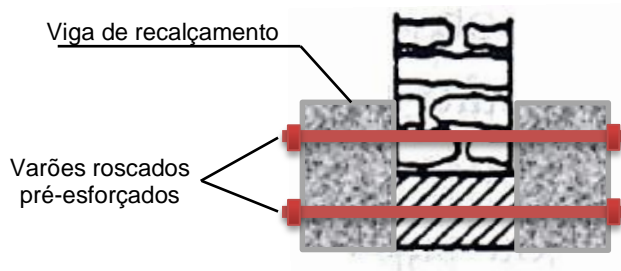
REFORÇO DE FUNDAÇÃO CONTÍNUA COM RECURSO A VIGAS DE RECALÇAMENTO PRÉ-ESFORÇADAS.
